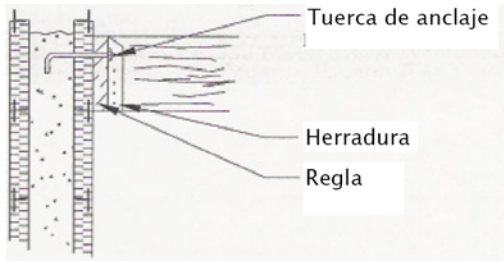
b. Conexión de piso de madera al muro Polycrete®
